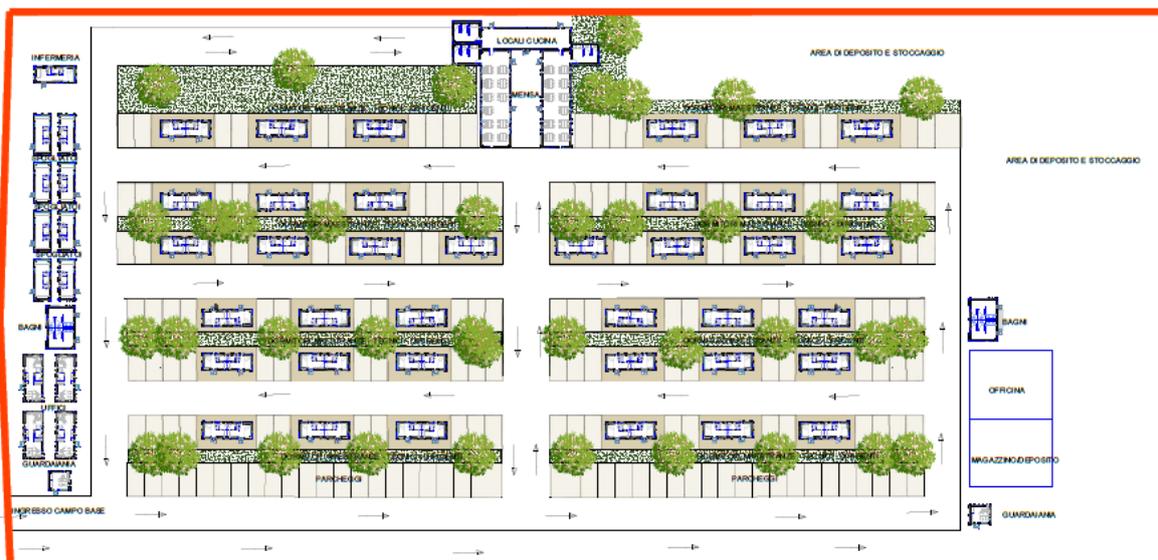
Stralcio della tavola "Cantierizzazione: ubicazione delle aree di cantiere e viabilità di servizio" (cod. elaborato T00IA02AMBCO02), layout Cantiere base.
